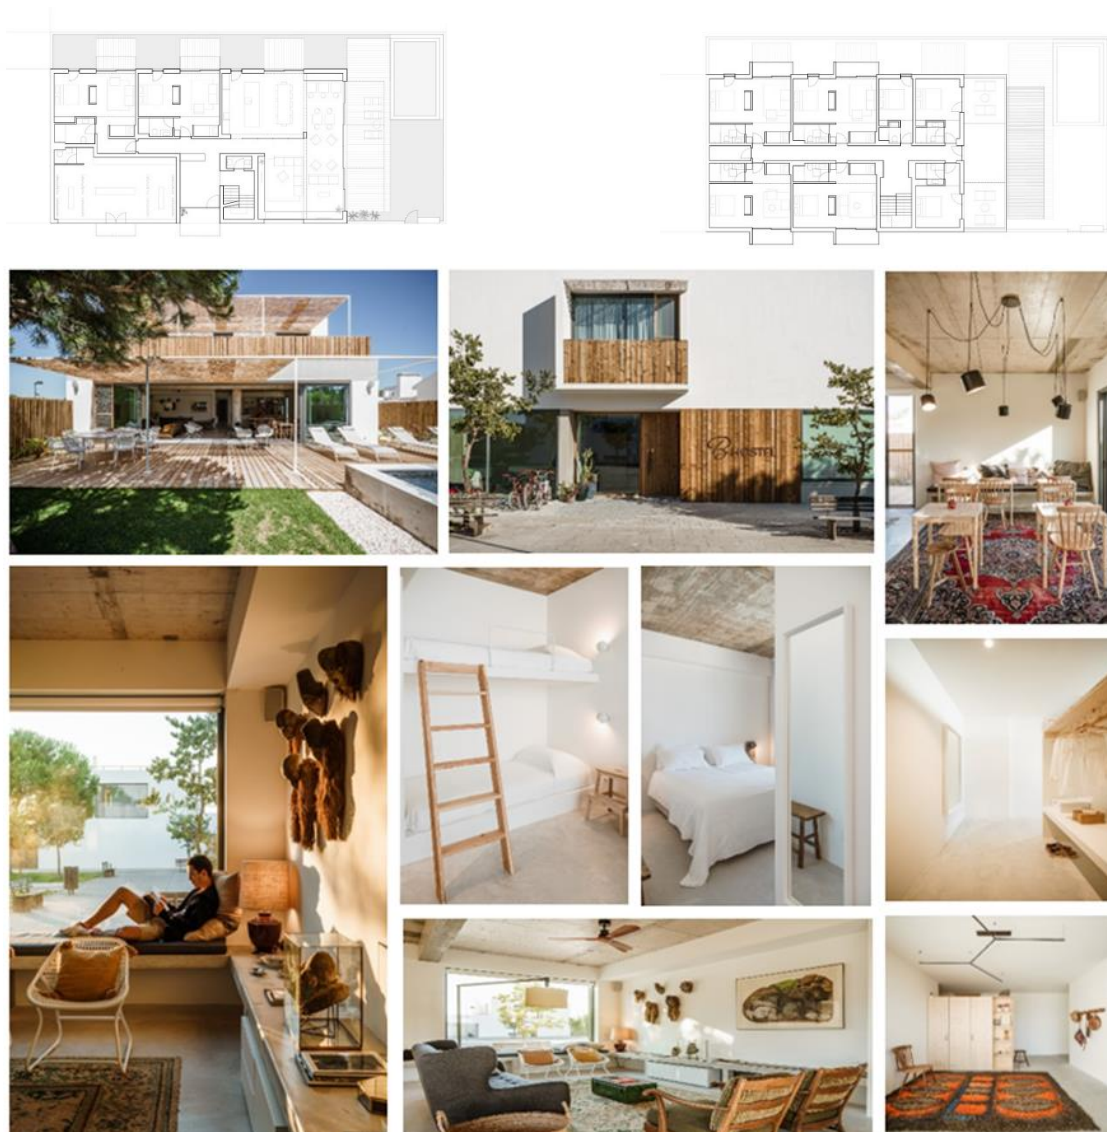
Planta e Fotografias do interior. Fonte: Archdaily.
